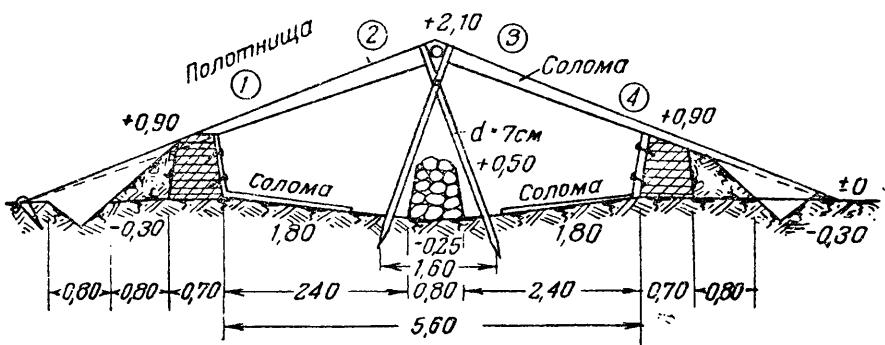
Утепленная палатка-землянка. Поперечный разрез по А — В
